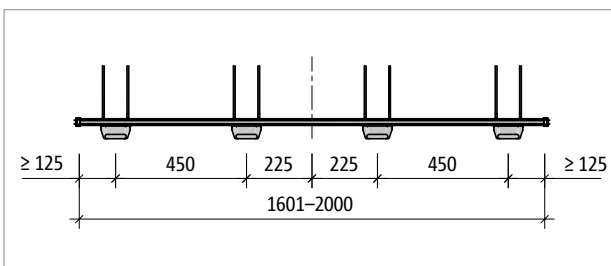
Schöck Tronsole® typ T-V4...-L700 až L1000: Půdorys prvku
